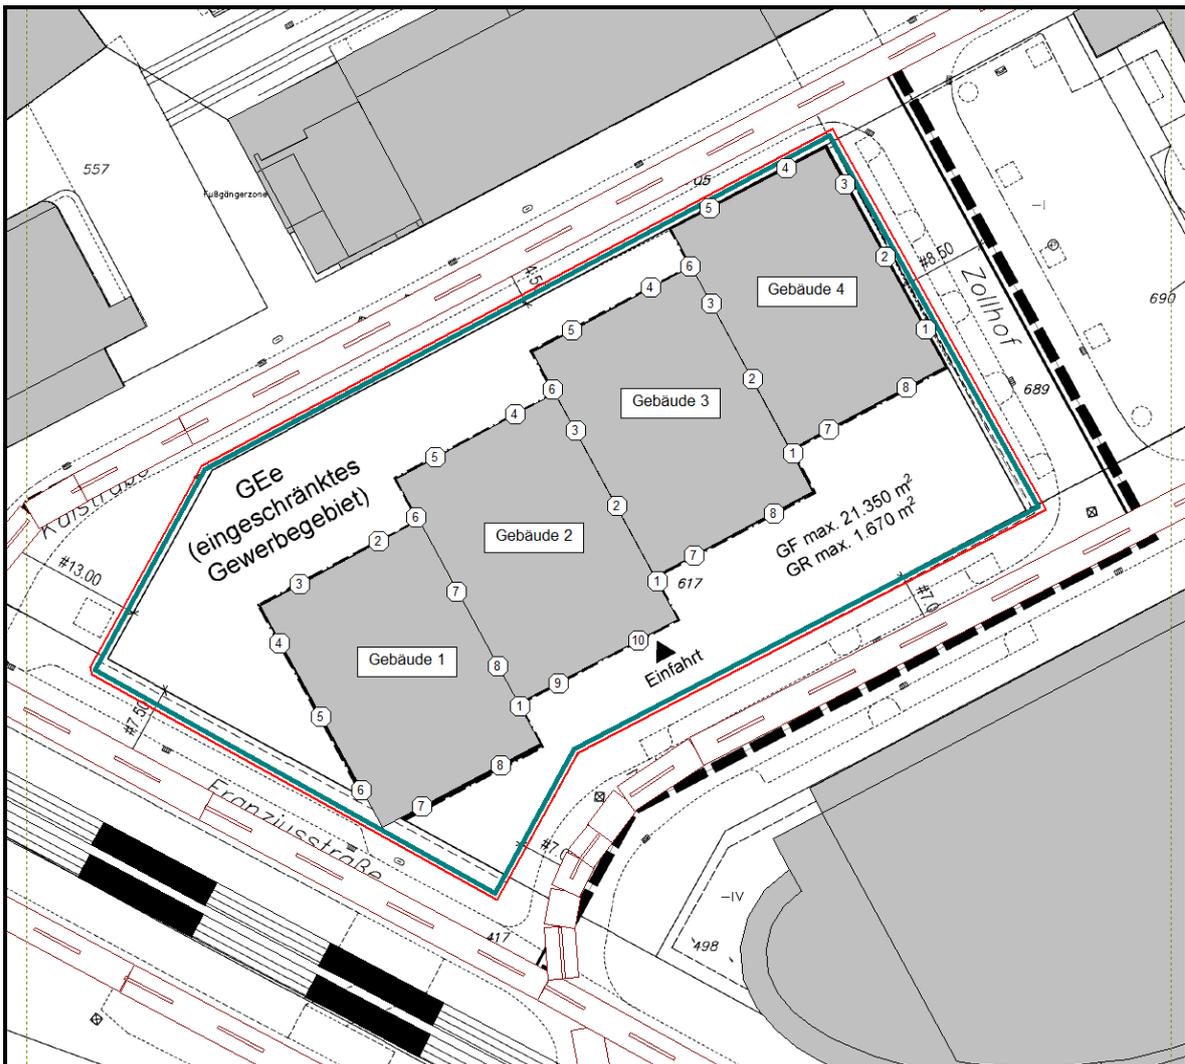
Auszug aus dem Berechnungsmodell mit Darstellung der Fassadenabschnitte der geplanten Gebäude
